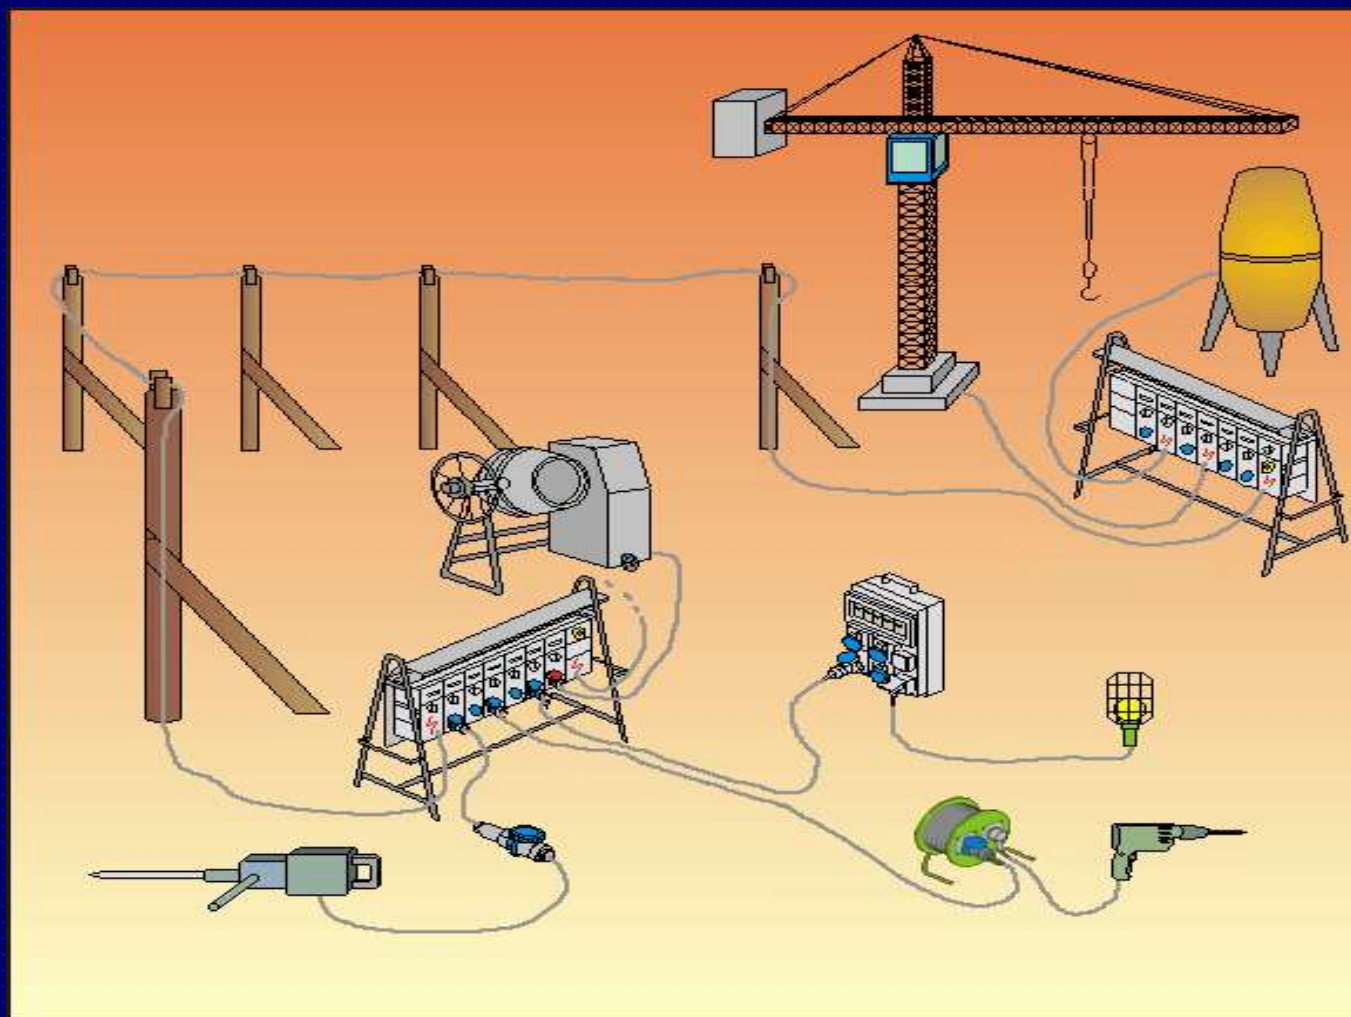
Esempi di distribuzione e posa delle condutture in un cantiere
